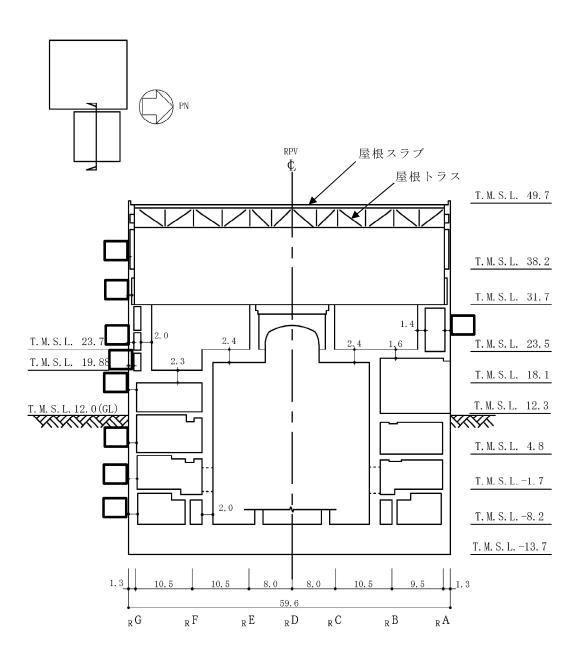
原子炉建屋の概略断面図 (EW方向) (2/2) (単位:m)
